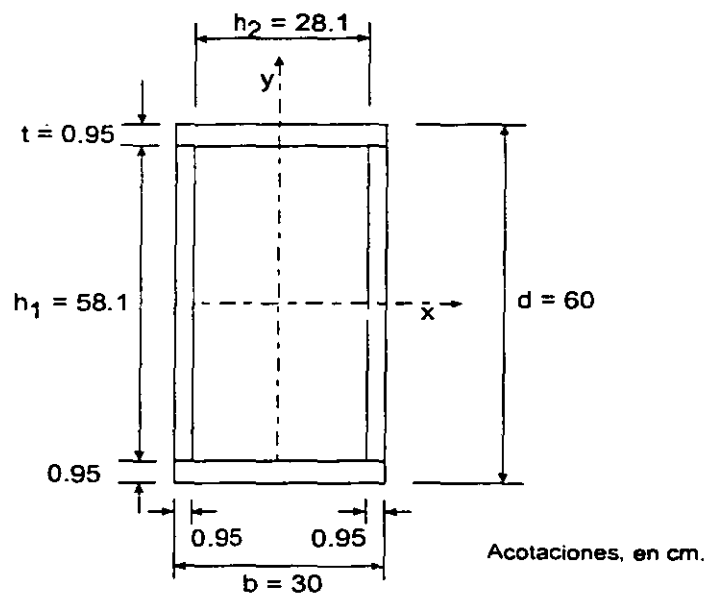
Sección transversal de la columna del ejemplo 2.5.
